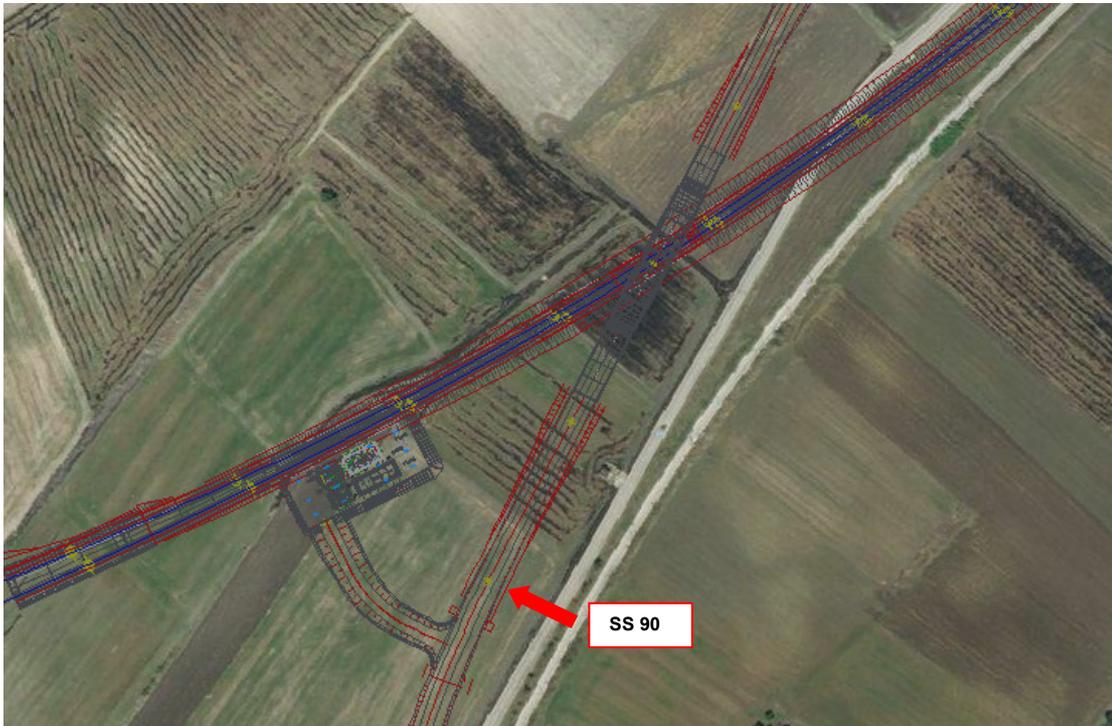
Bovino - Configurazione planimetrica dell'intersezione tra la SS90 e la linea ferroviaria di progetto.
